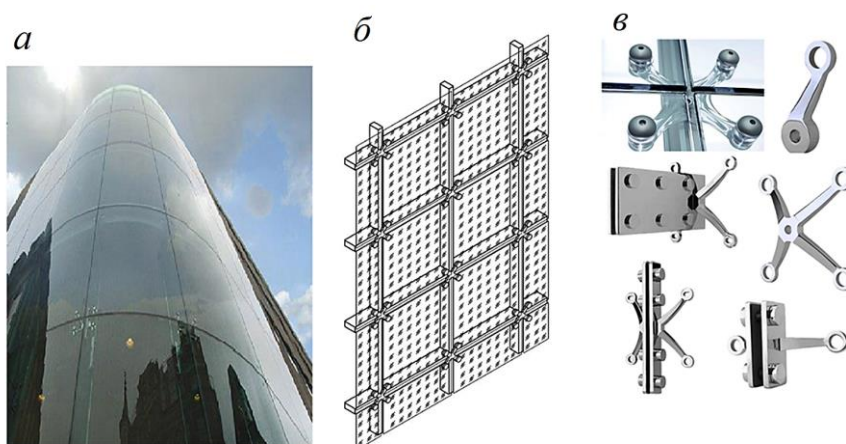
Система спайдерного остекления фасада: а – общий вид фасада;
